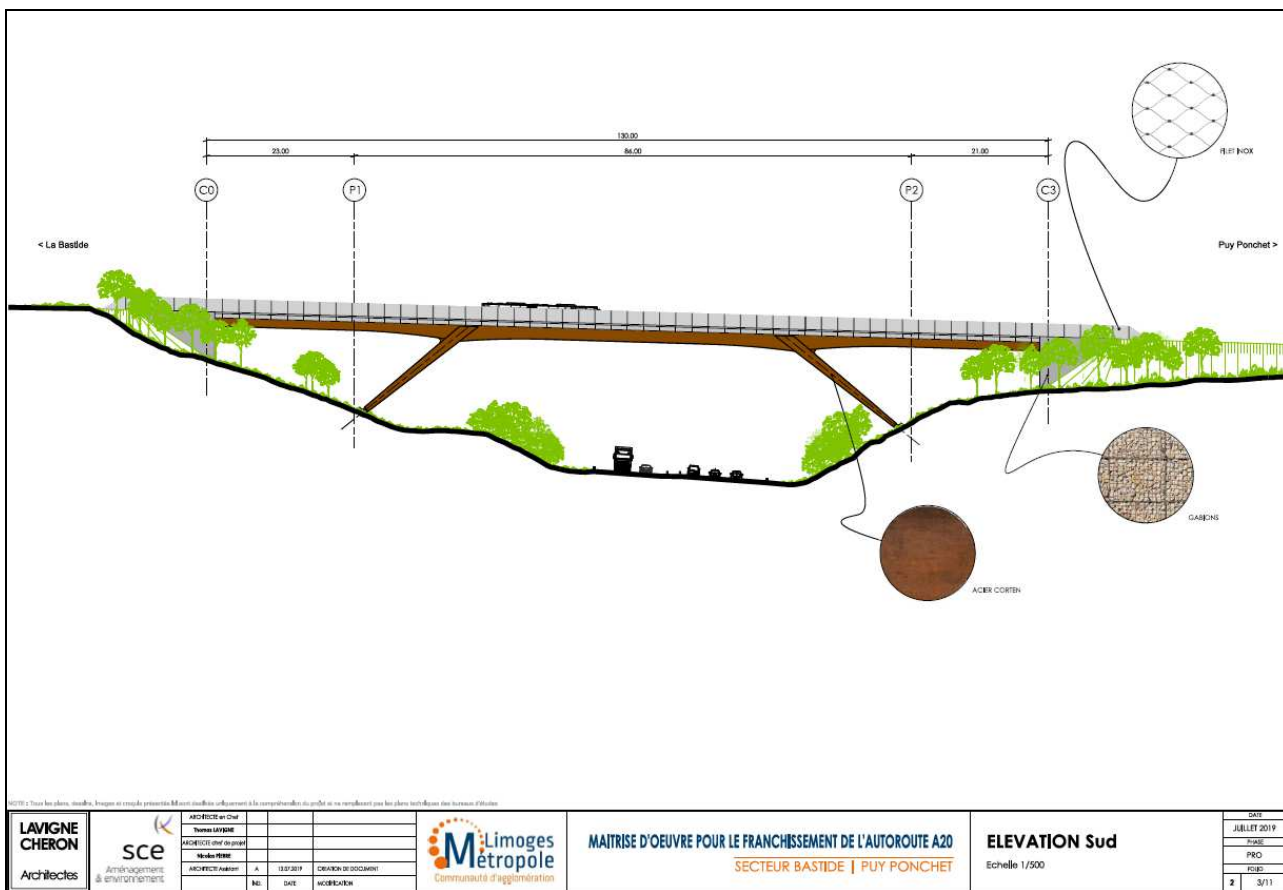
Illustration de l'ouvrage de franchissement - Elévation Sud (dossier PRO)
